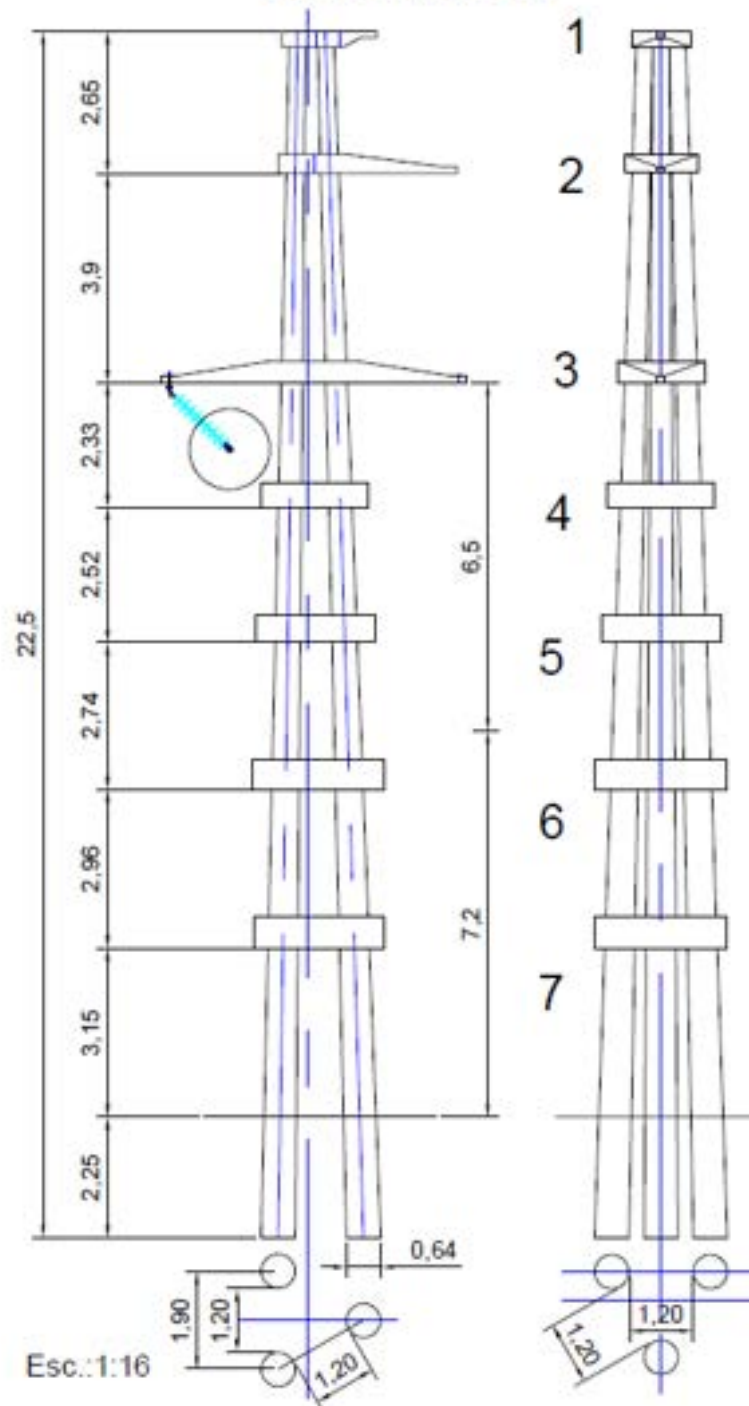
Dimensiones de las estructuras en 132 kV, simple terna. Primer estructura luego del pórtico de la ETPY.
